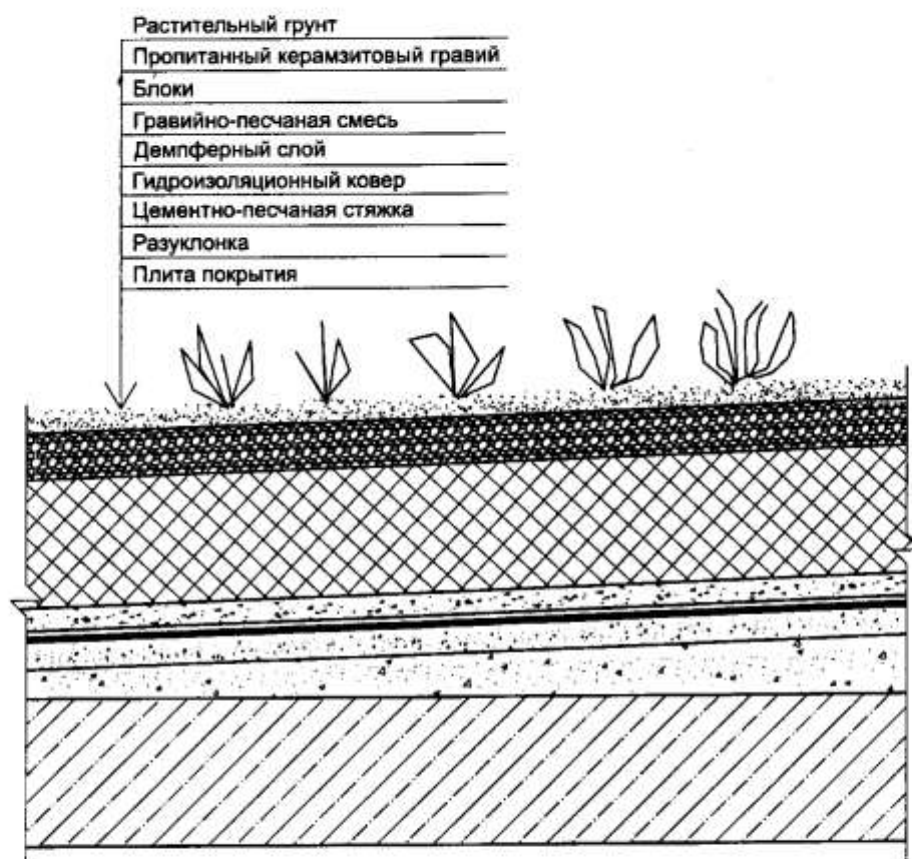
Тепловая изоляция инверсионной кровли с озеленением
